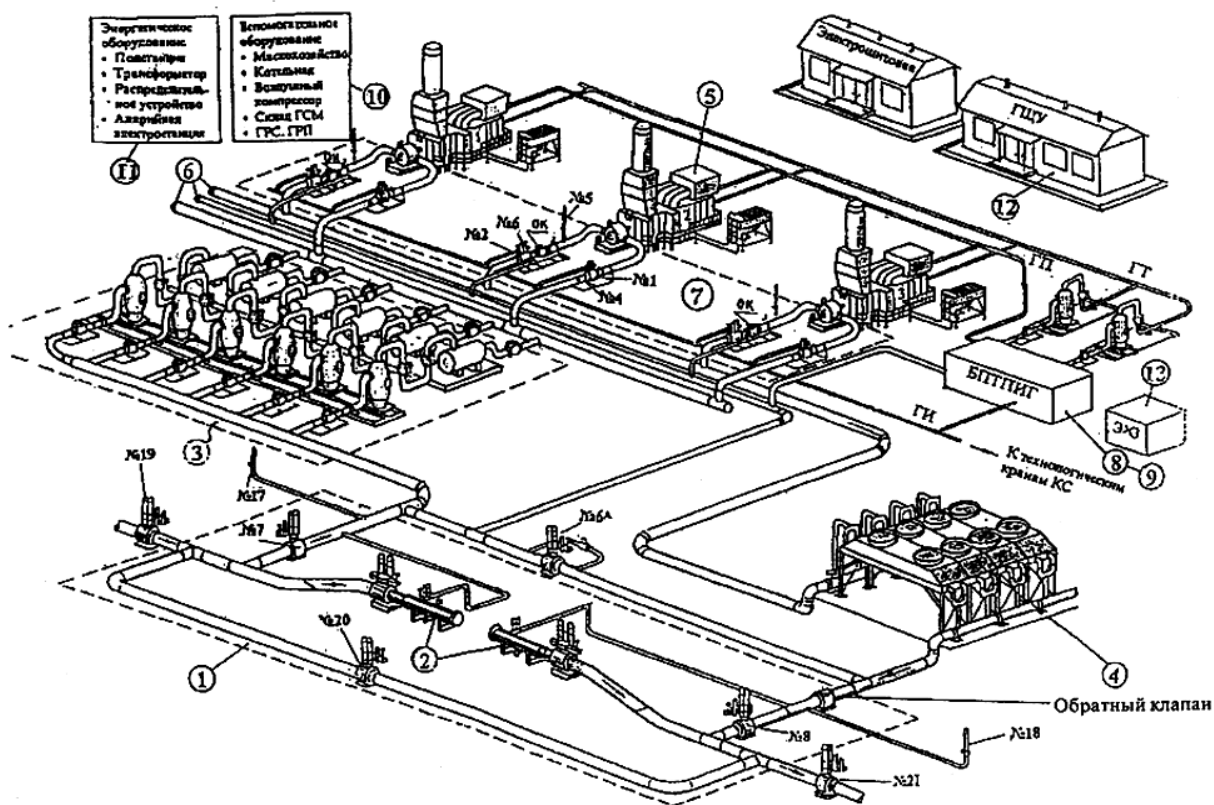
Принципова схема компоновки основного устаткування компресорної станції
